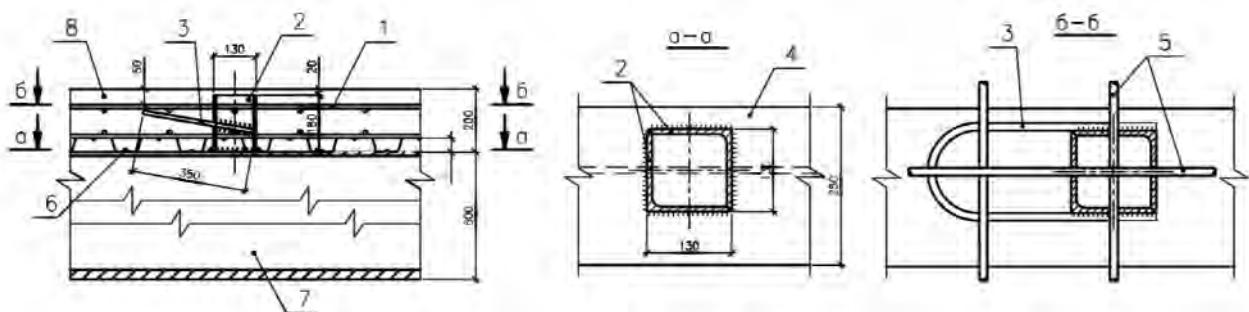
Конструкция дискретно-континуальные связи сдвига: 1 – арматурный каркас плиты; 2 – жесткий упор из уголков; 3 – арматурный выпуск; 4 – верхний пояс балки; 5 – арматура объединения с упором; 6 – профилированный настил; 7 – главные балки; 8 – железобетонная плита проезжей части
